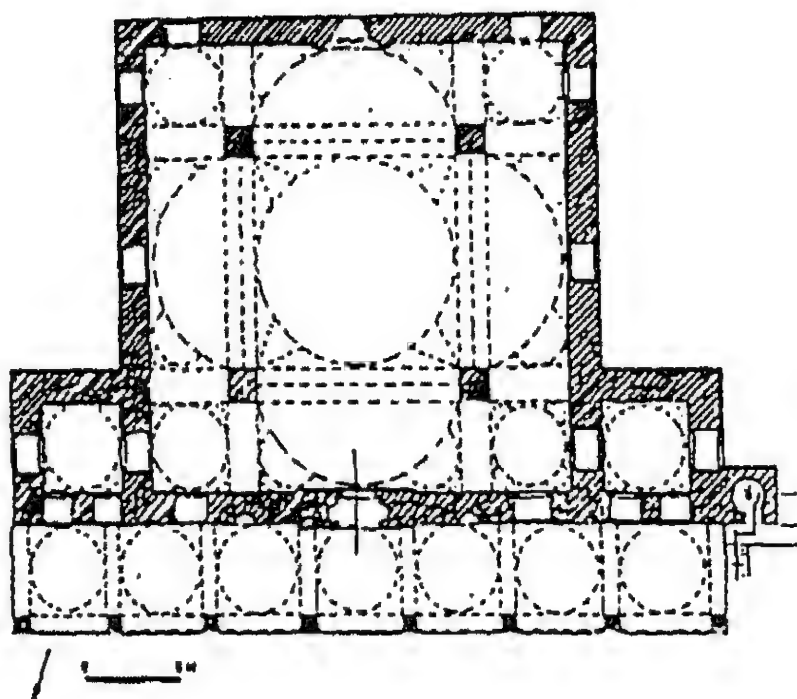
مسقط أفقي لمسجد چلبی سلطان محمد فی دیموتیکا (عن : اصلان ابا)
